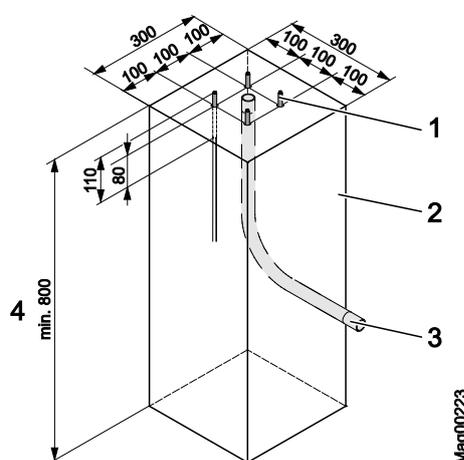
План для изготовления фундамента под опорную тумбу или тумбу для фоторелейного барьера
